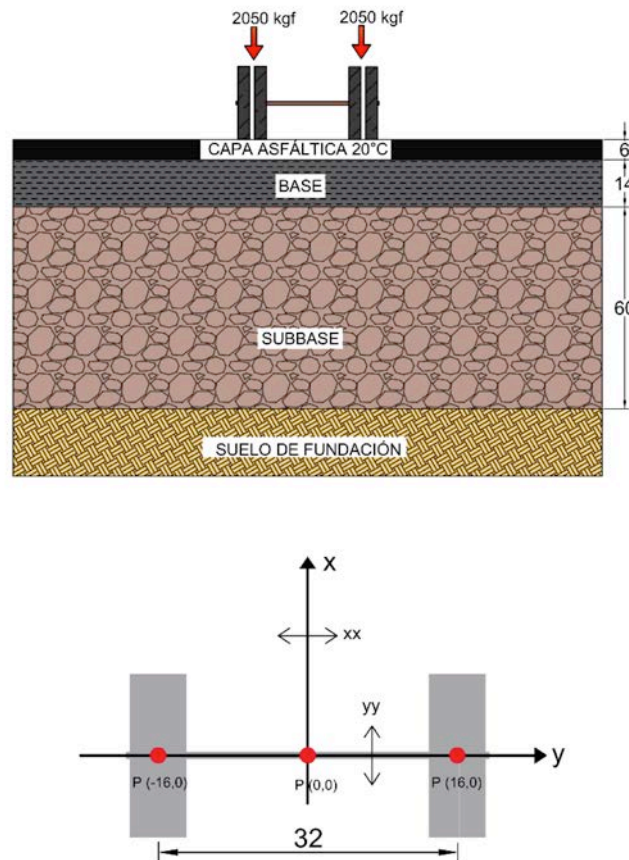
Representación del eje actuante sobre la estructura del pavimento (dimensiones en centímetros)
